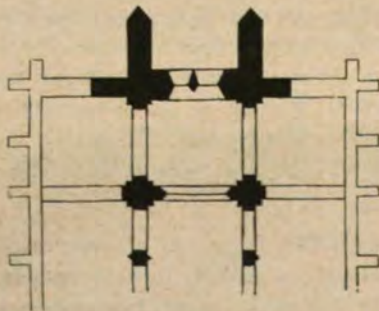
Grundriss des Thurmes nach Mauch.
